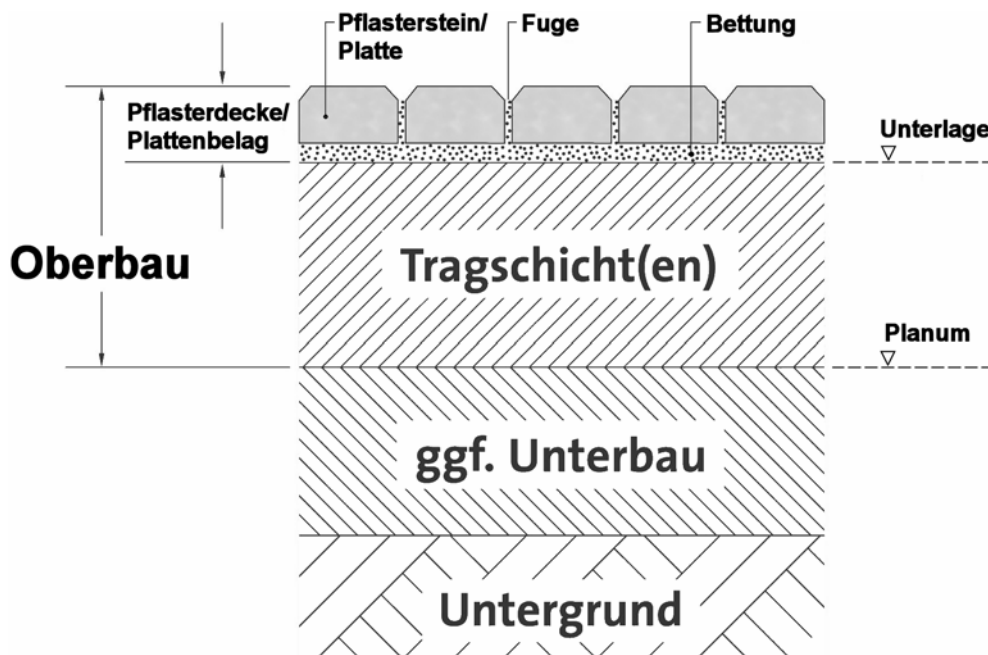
Bauweise mit Pflasterdecke nach ZTV Pflaster-StB [30]
